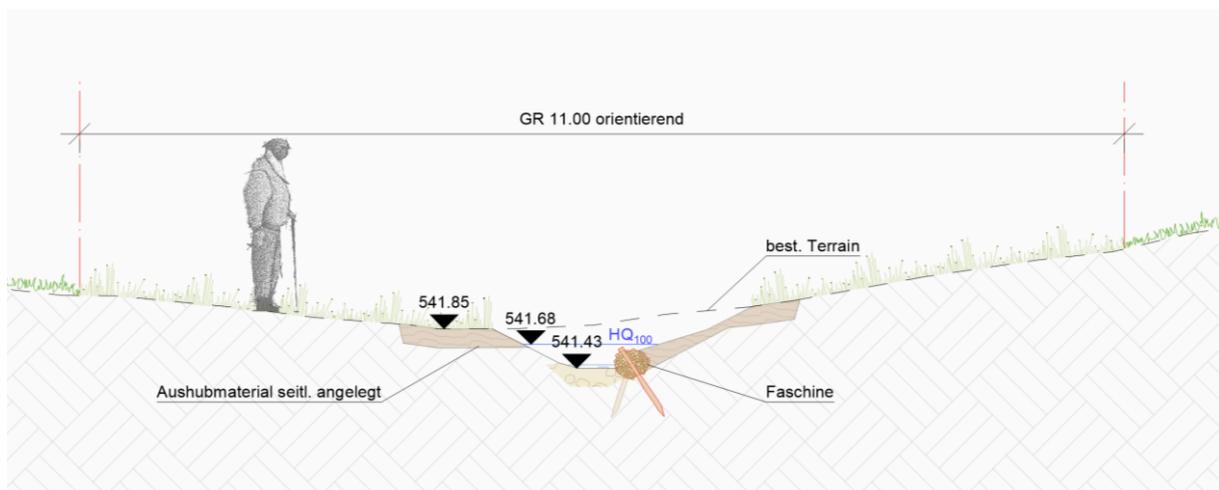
Ausschnitt aus dem Plan, Querprofil 1.
